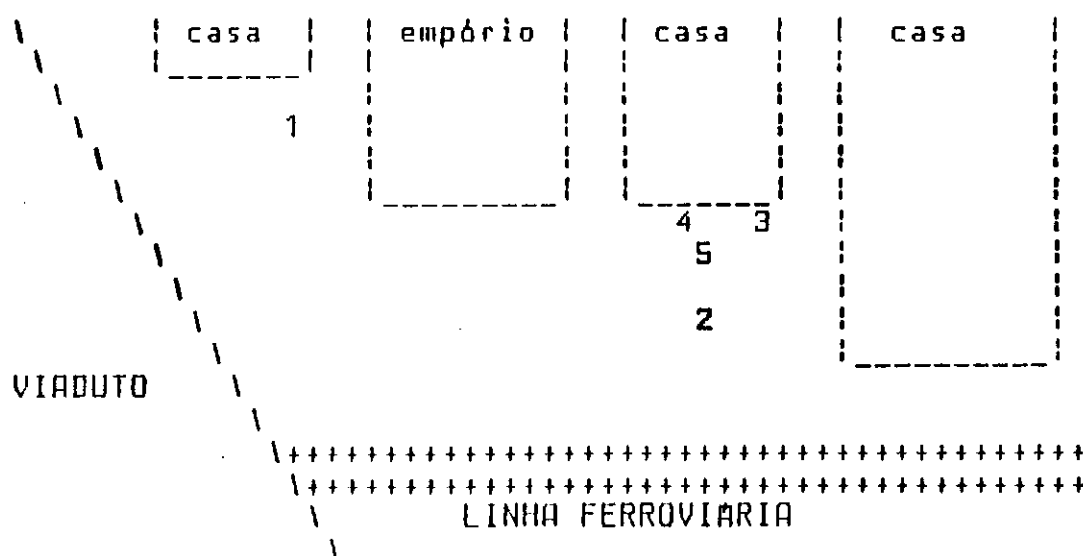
Planta Esquemática dos Furos de Sondagem
